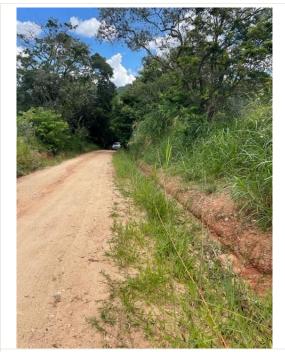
Perfil AMP_18 no bairro Parque do Sol
